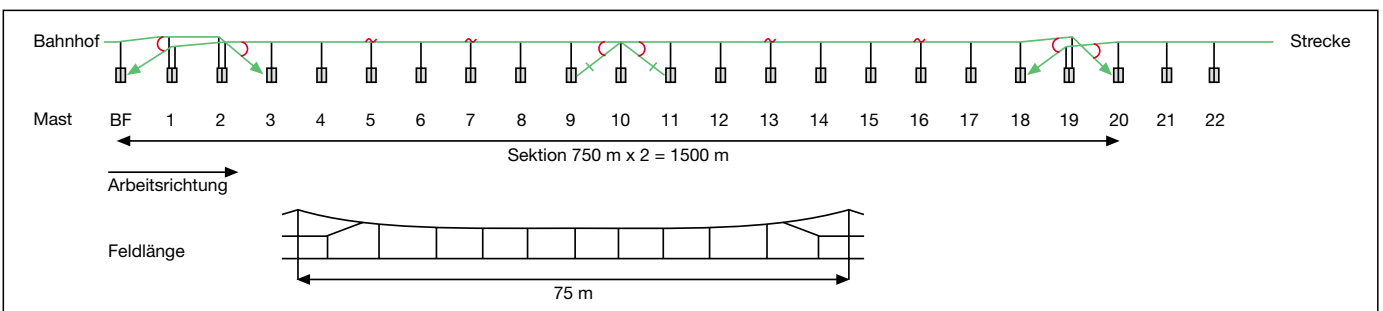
Prinzip-Lageplan der abzutragenden Oberleitungsanlage
